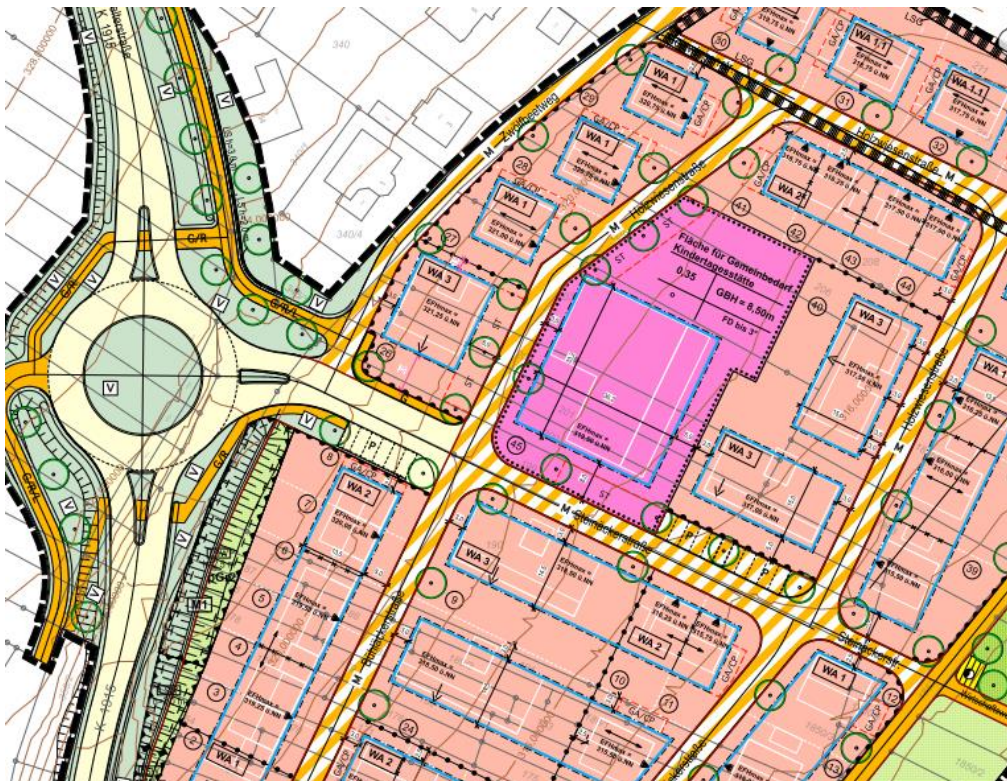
Bebauungsplan „Hanfäcker“ (Auszug) vom 07.06.2018.
